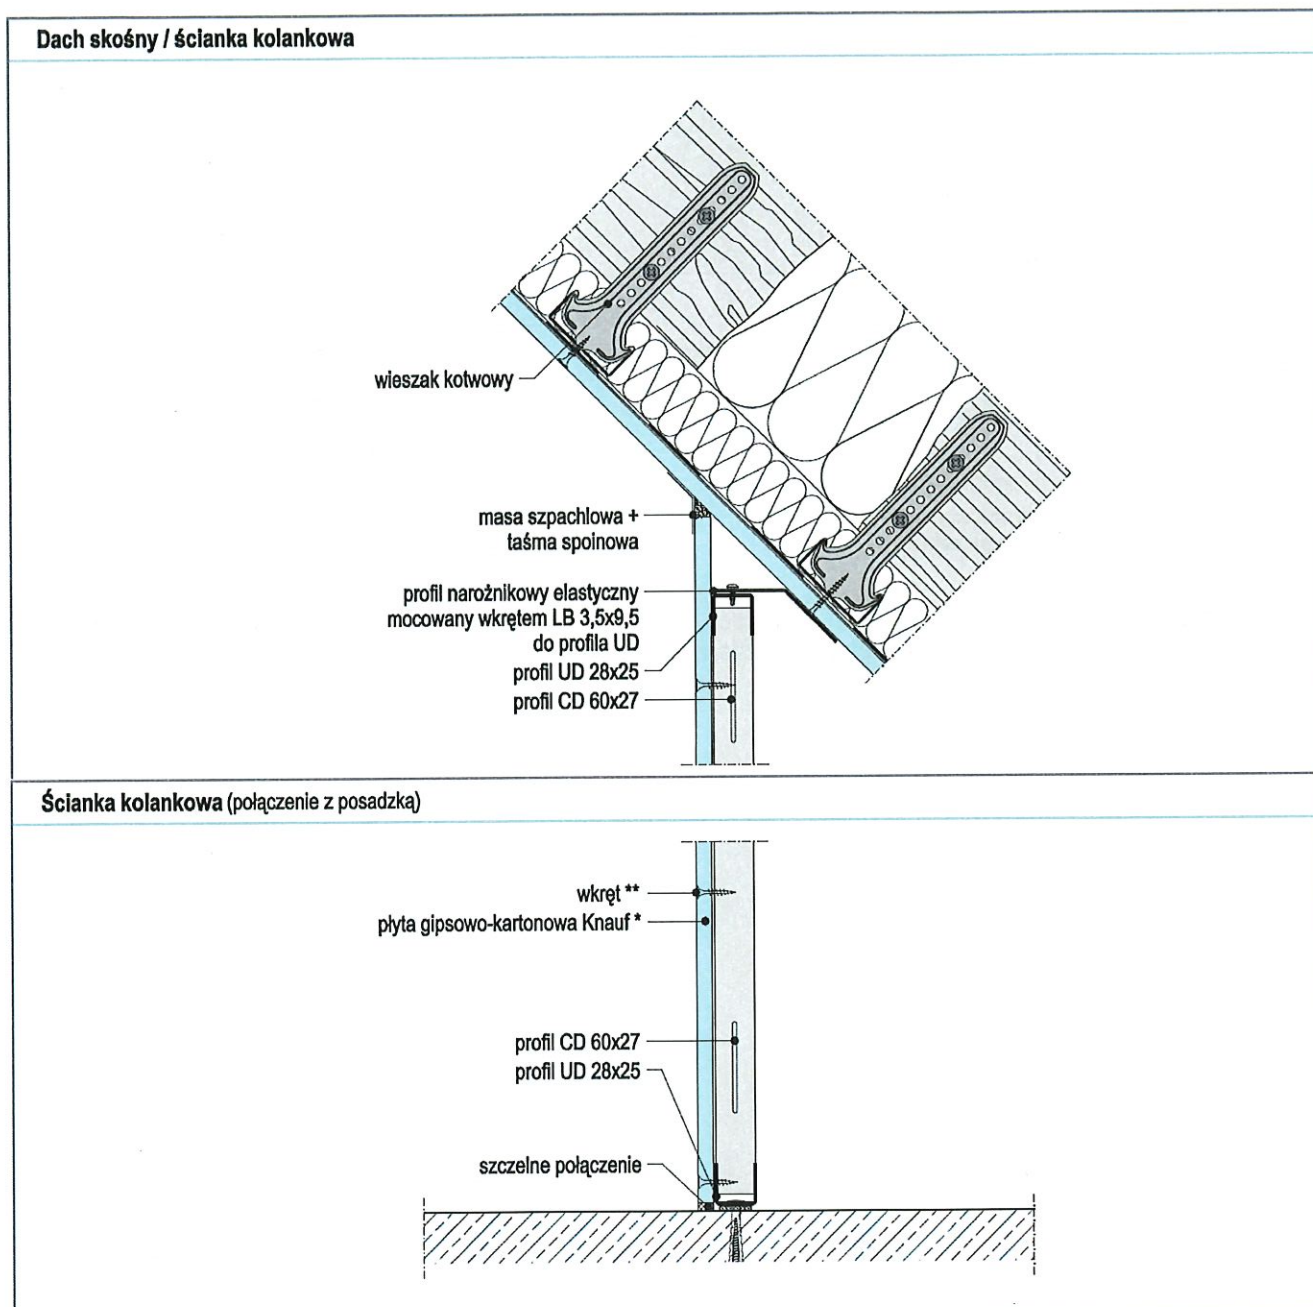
System D612.pl na pojedynczej konstrukcji z wieszakiem kotwowym, przekrój pionowy dachu spadzistego.
